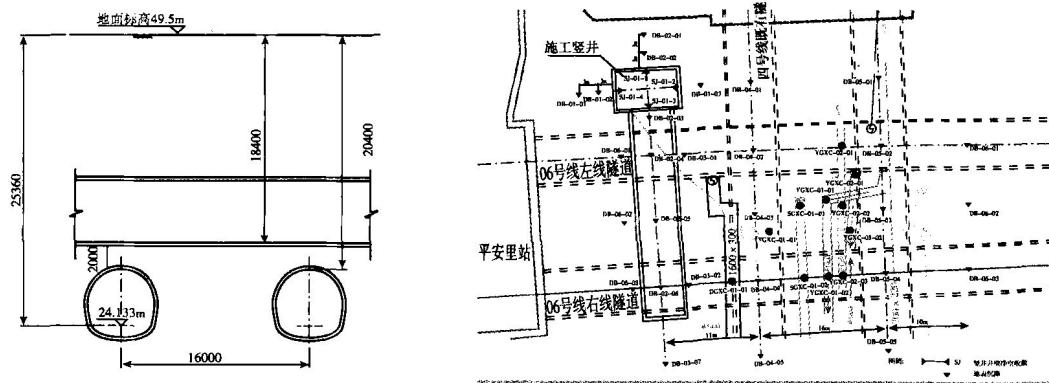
下穿既有线的位置关系图和监测点布置图 (尺寸单位: mm)
